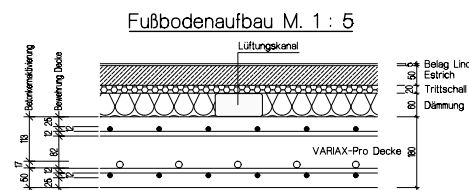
Fußbodenaufbau mit Heizung durch Betonkernaktivierung (nicht maßstabsgetreu)
